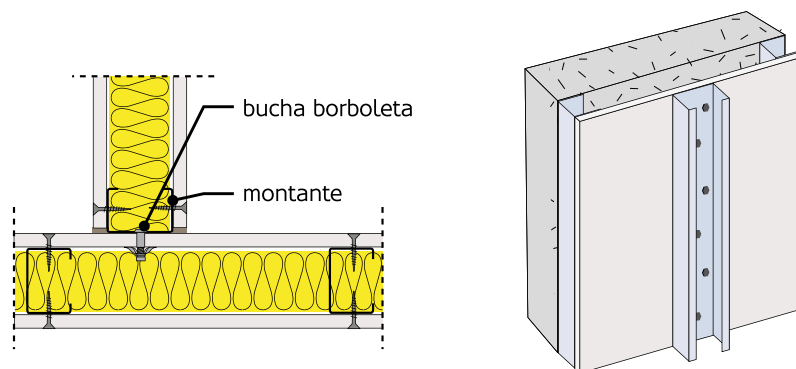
Ligação de um perfil montante de arranque a um sistema existente.
